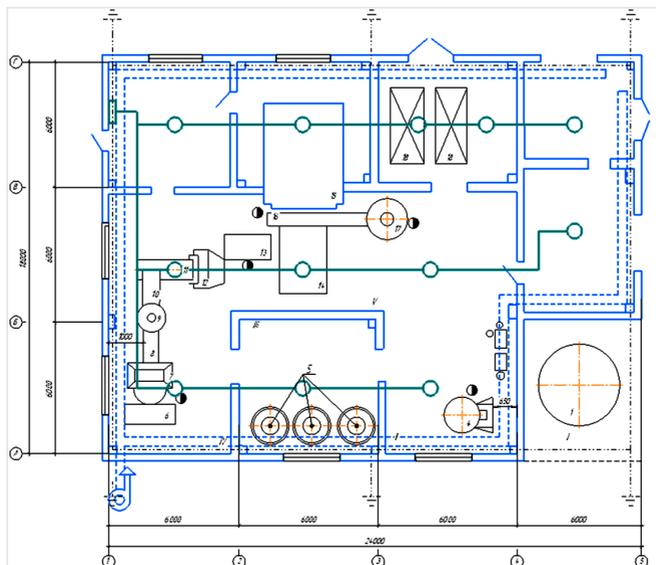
План реконструкции систем вентиляции и освещения в тестомесильном цехе
